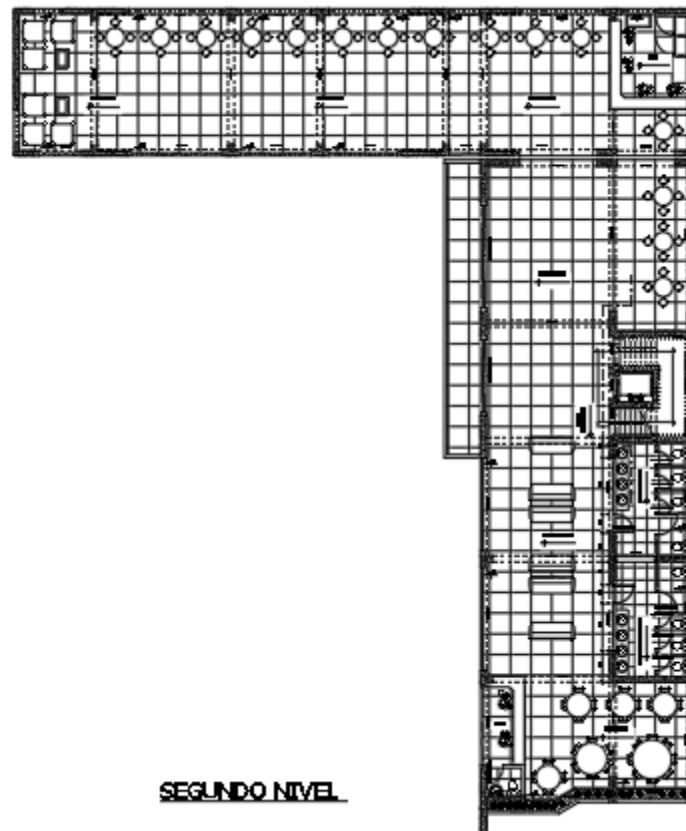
Plano en Planta Segundo Nivel del Hotel.
